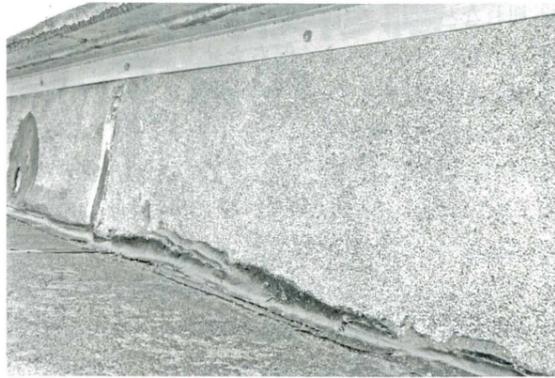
新築時の保護コンクリートの施工不良によるアスファルト防水層の破断状況、部分補修が可能。
